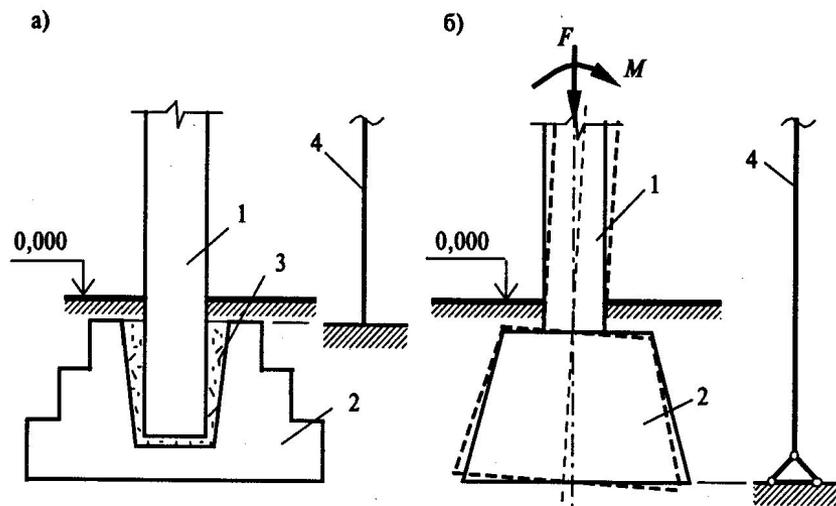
Заделка железобетонных колонн в фундаментах:
